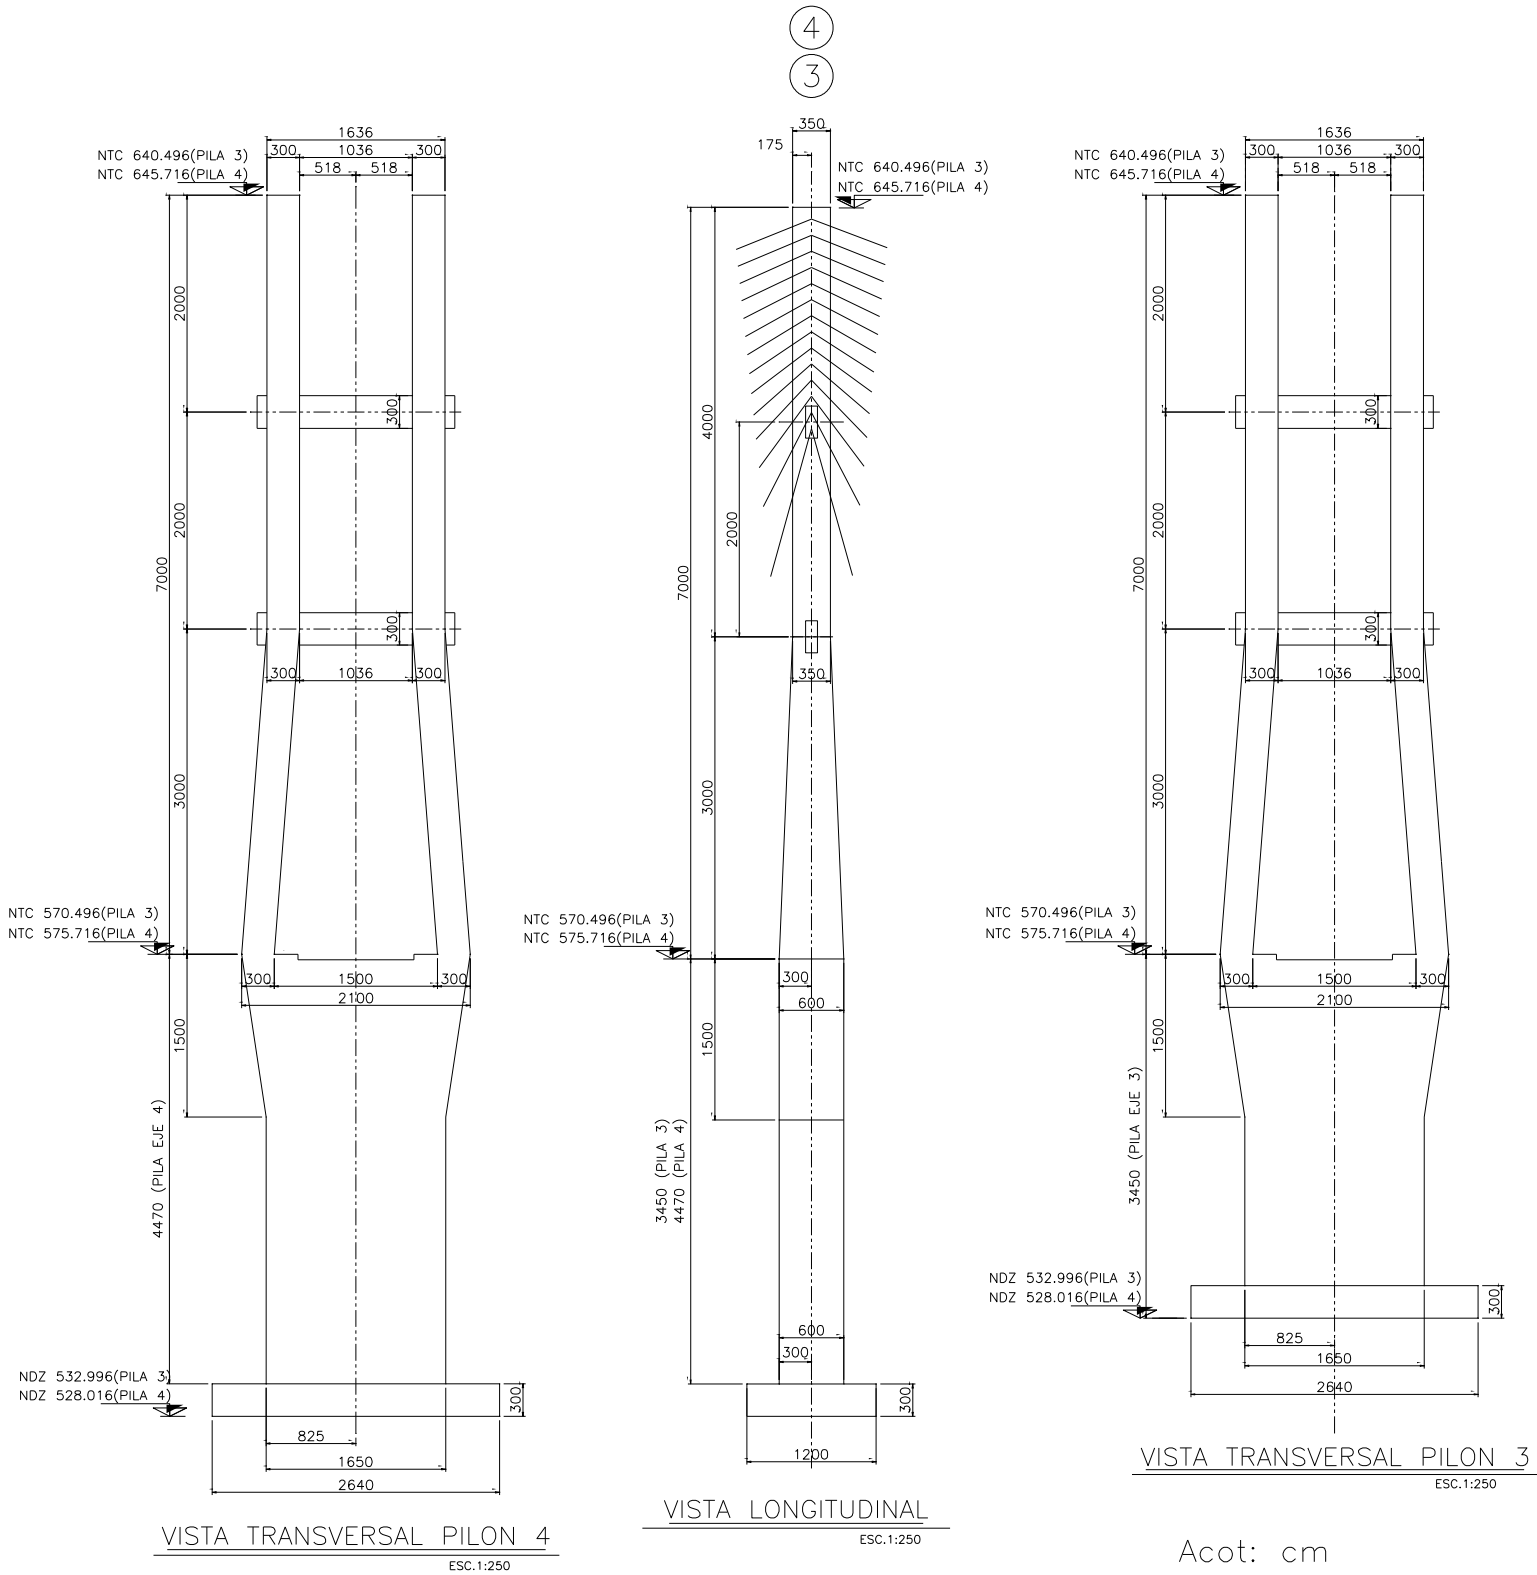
Vista general en alzado de los pilones 3 y 4
